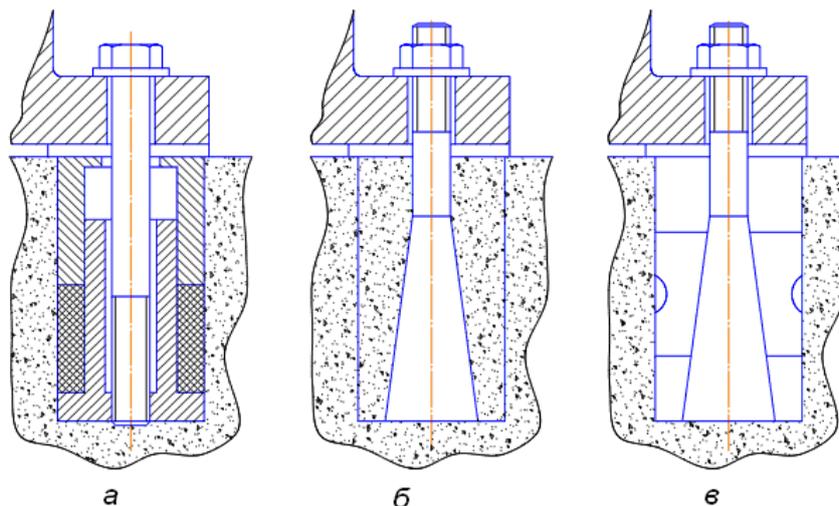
Крепление станков болтами, устанавливаемыми в скважинах на готовых фундаментах:
